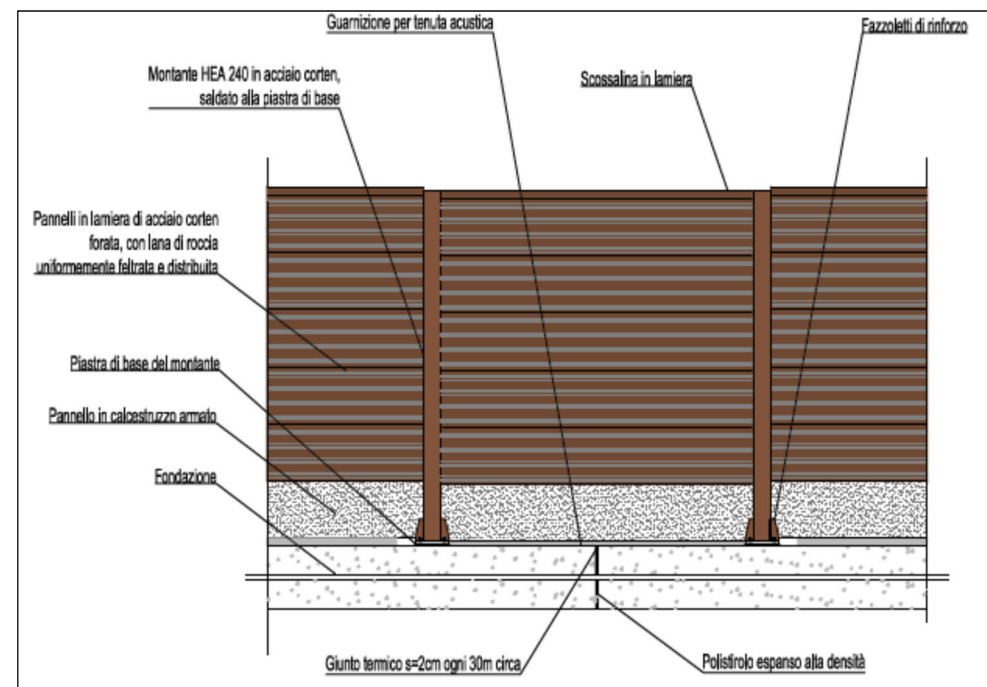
Prospetto delle barriere opache in corten da 3 metri
